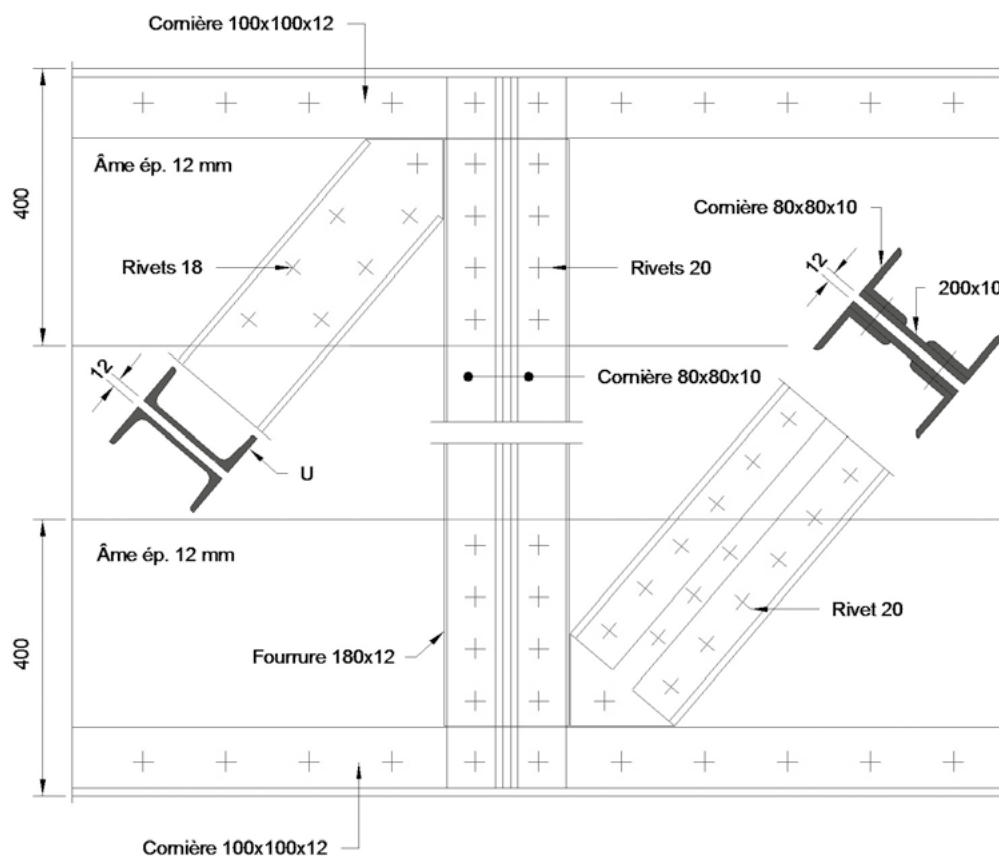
Principales dispositions constructives mises en œuvre sur les poutres treillis (exemple)
